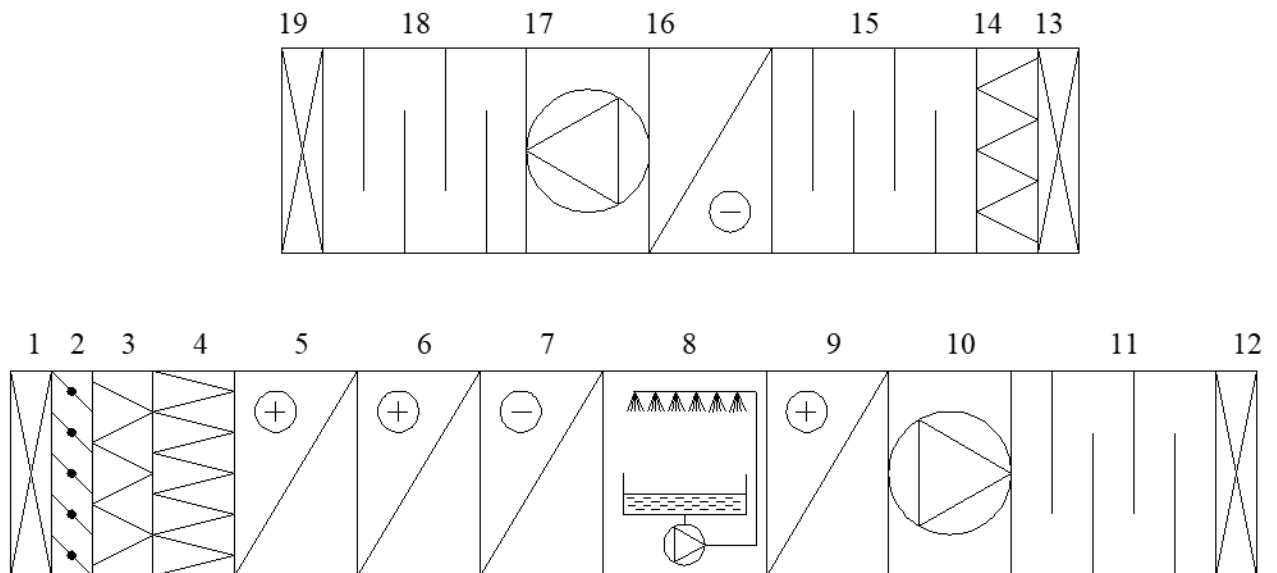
Припливно-витяжний агрегат KLM 40
